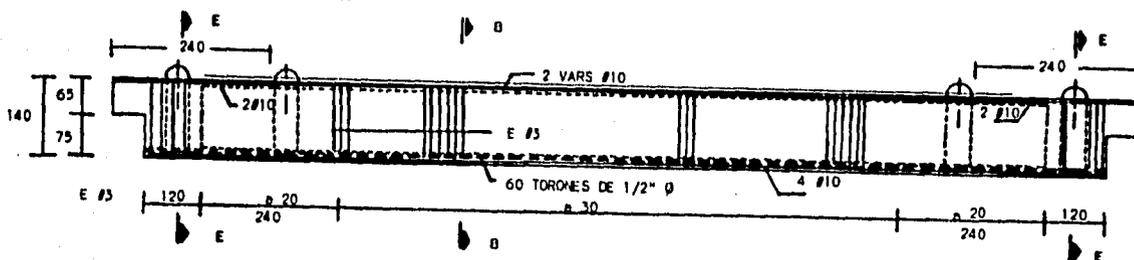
ARMADO LONGITUDINAL DE TRABE T-C
